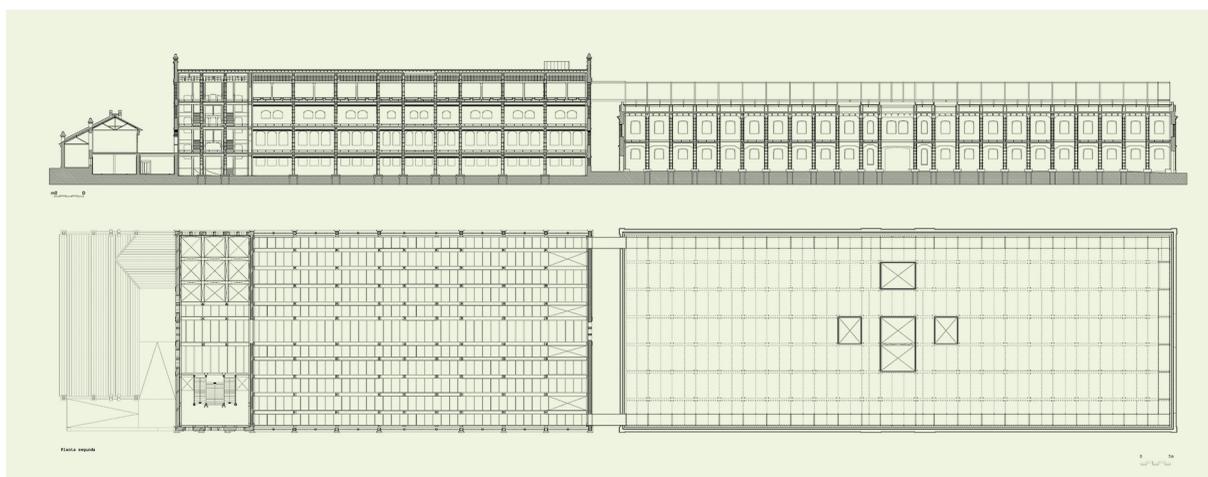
Planta y sección longitudinal de las naves 8 y 9. [Fuente: del autor, Arturo Franco]
